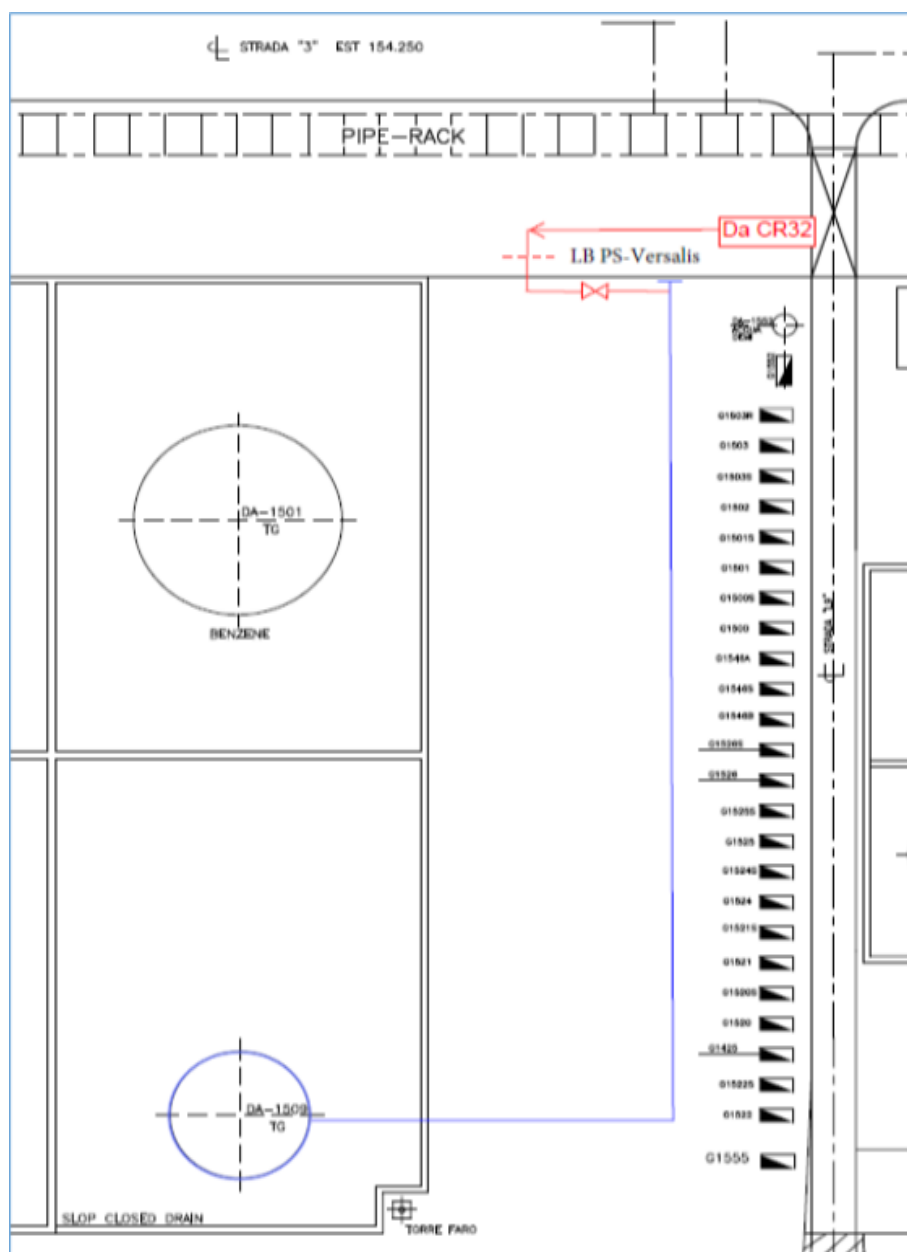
Posizionamento planimetrico del serbatoio DA1509 in area stoccaggi CR15 Impianti Aromatici
